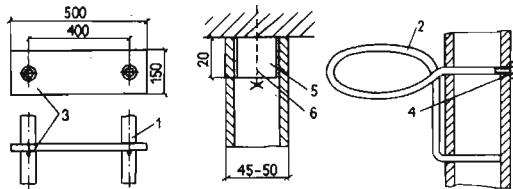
Бамбуковая стена для цветов; слева — дощечка с отверстиями для продевания бамбуковых стоек; посередине — деталь крепления бамбуковых стоек к потолку; справа — держатель цветочных горшков
